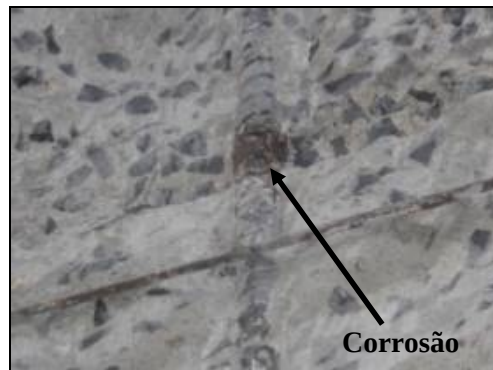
Pontos de corrosão das armaduras nas posições de fissuras do revestimento do edifício 2
